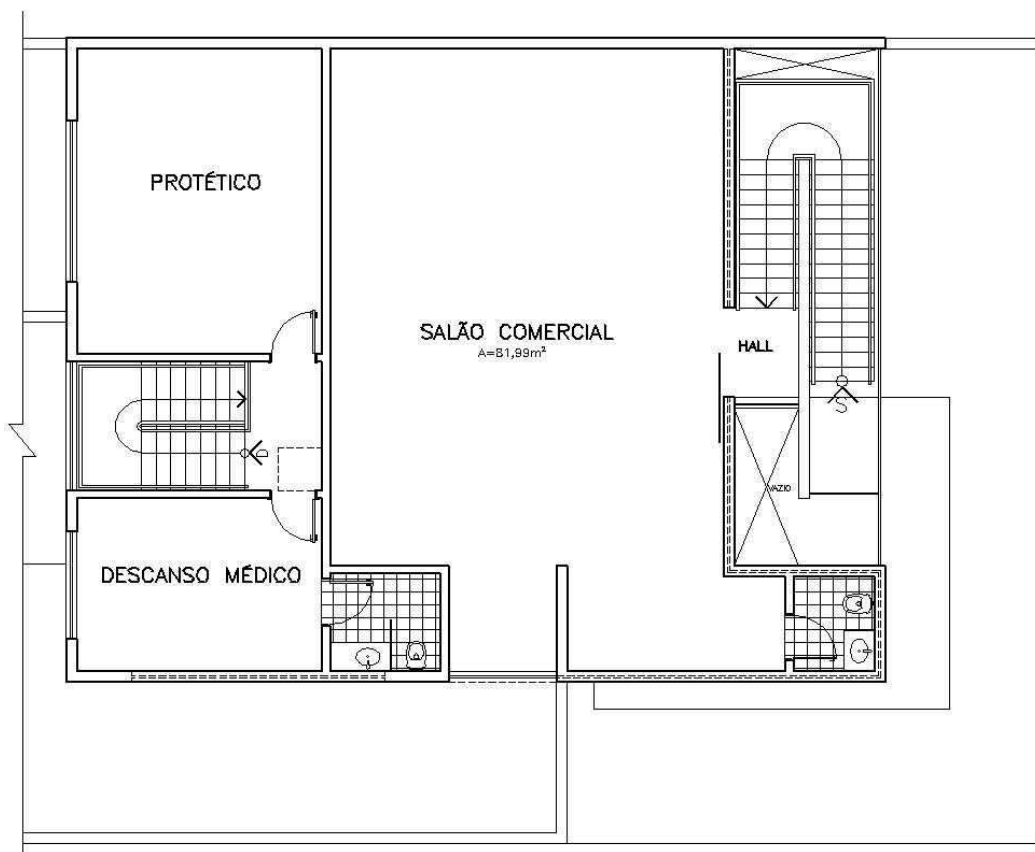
Planta baixa do 1º Pavimento – Obra C
